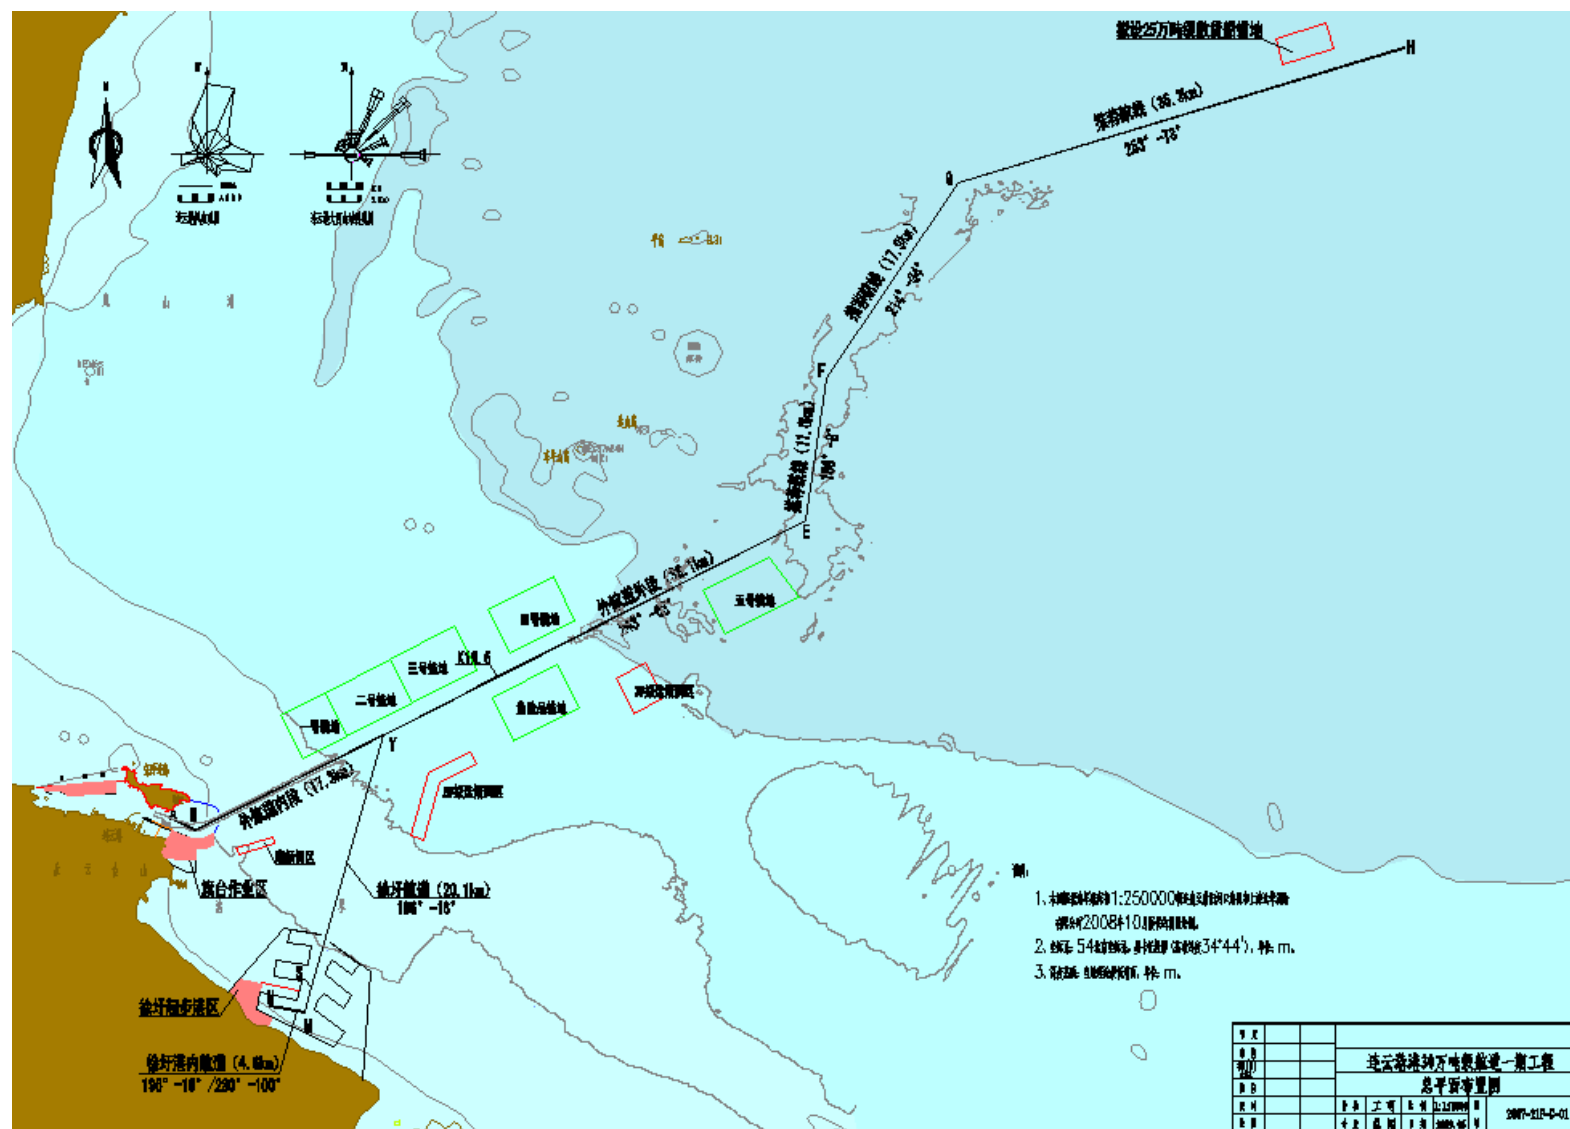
连云港港 30 万吨级航道一期工程平面布置图
